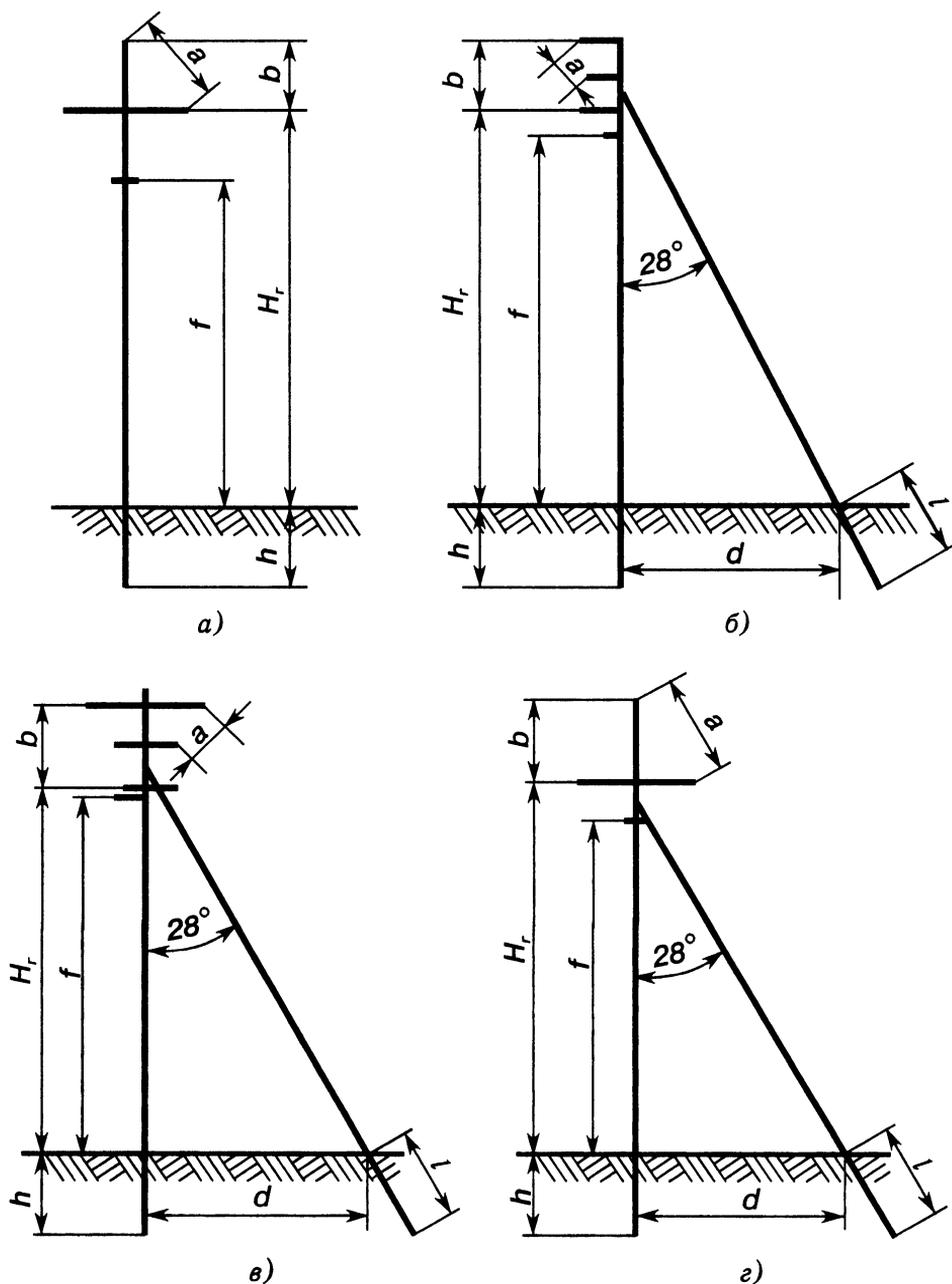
Схемы железобетонных опор ВЛ 6–10 кВ по типовому проекту 3.407–101.
